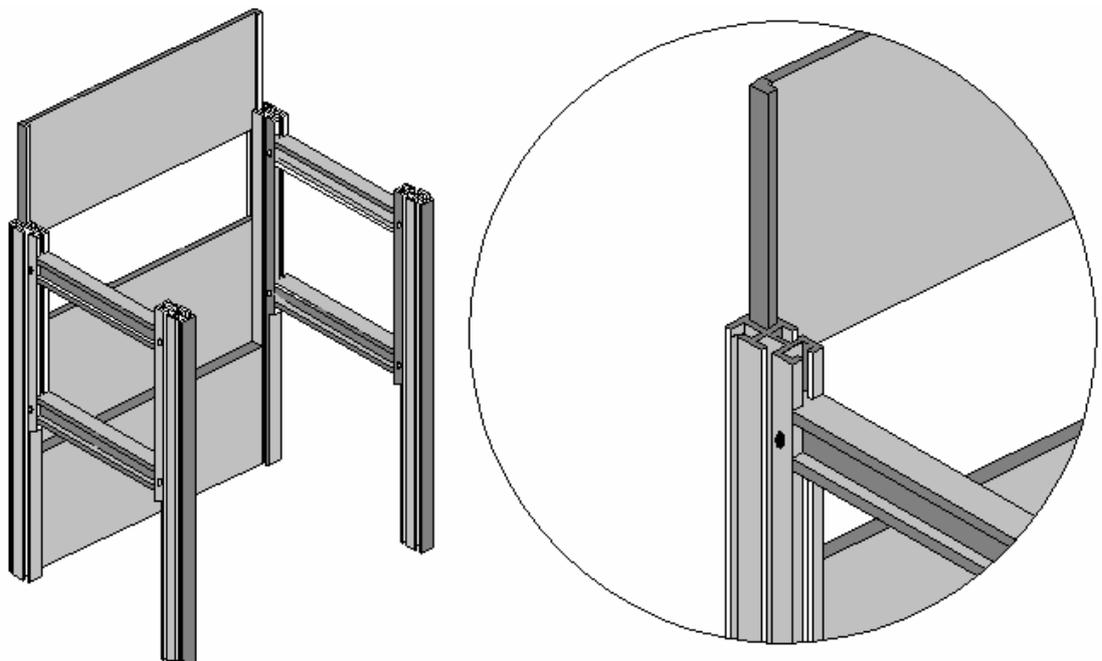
Vista Isométrica Entibaciones Metálicas, Sistema Paralelo con detalle ampliación de la esquina superior./Elaboración Propia.
